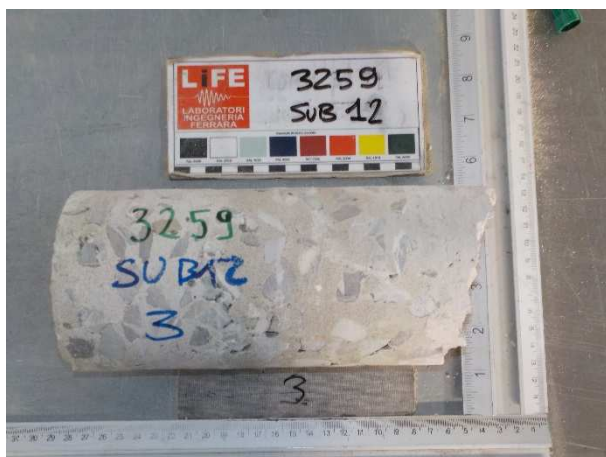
accettazione fotografica del materiale prelevato in situ – ID3
